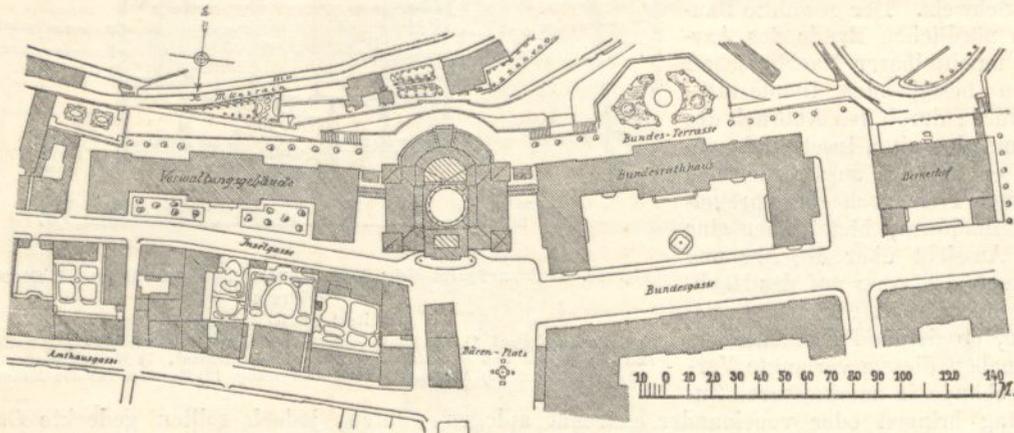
Entwurf zum eidg. Parlamentsgebäude in Bern. Situationsplan. II. Preis (Architekt Hans Auer).
